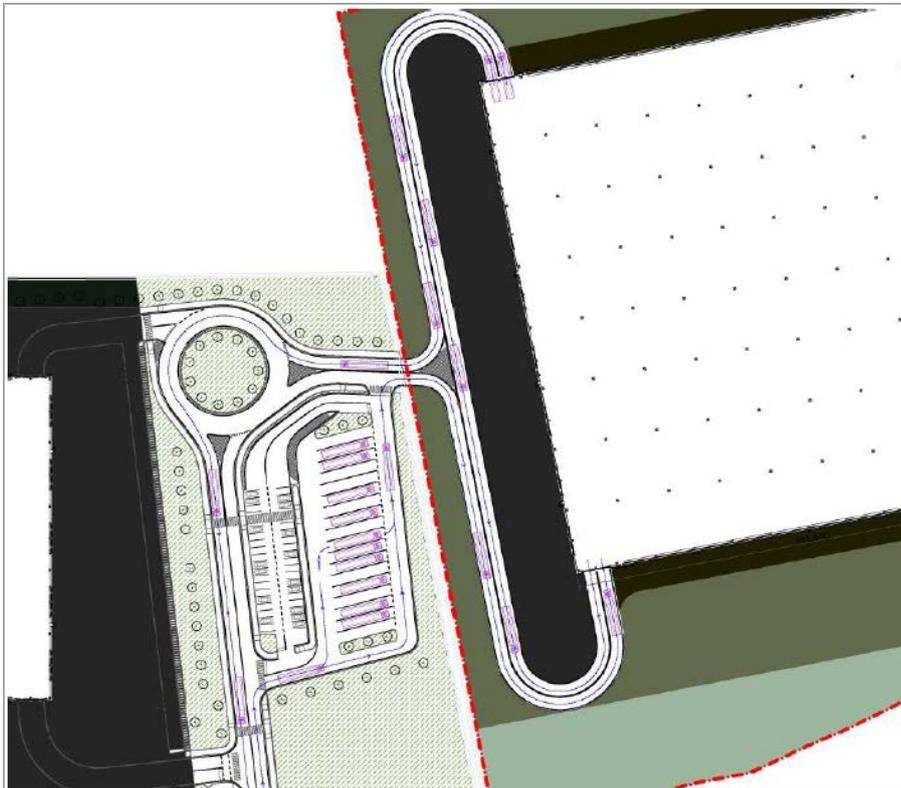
Planimetria d'insieme con individuazione della movimentazione dei mezzi e degli spazi di sosta
